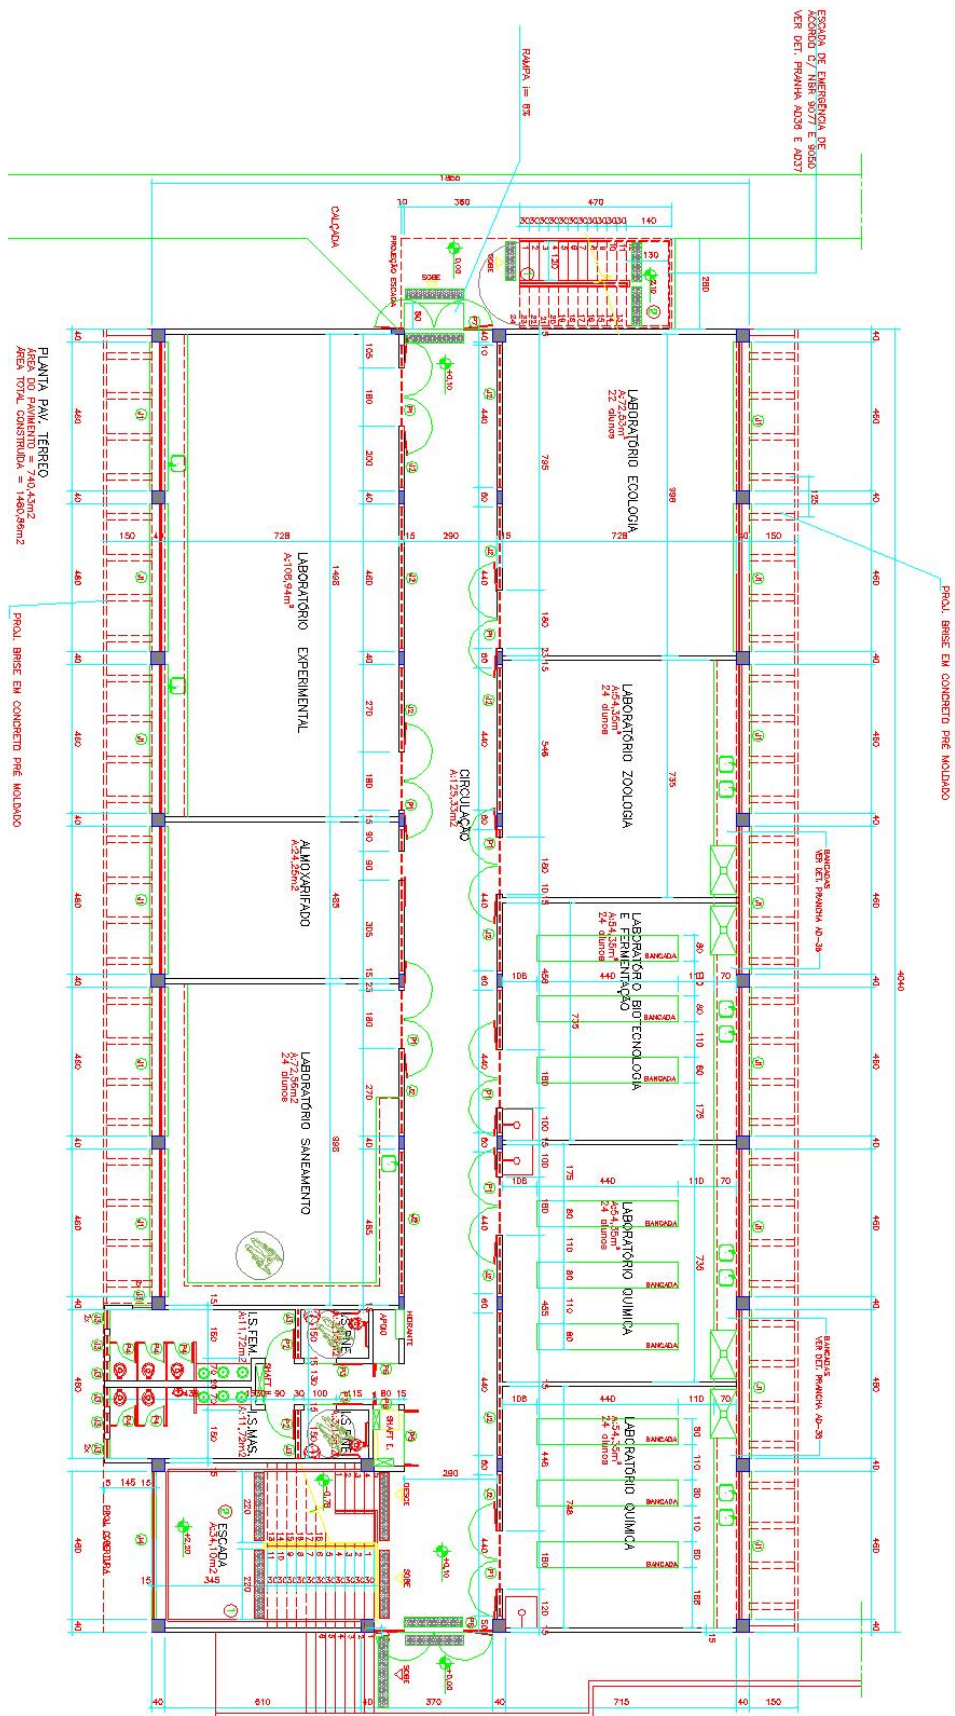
Planta baixa do pavimento térreo do Bloco G da UTFPR-CM
